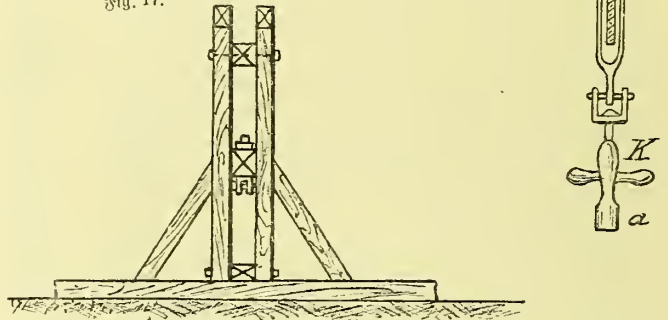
Bohrschwengel mit Ständer. — Fig. 17. Schwengelhänder.
